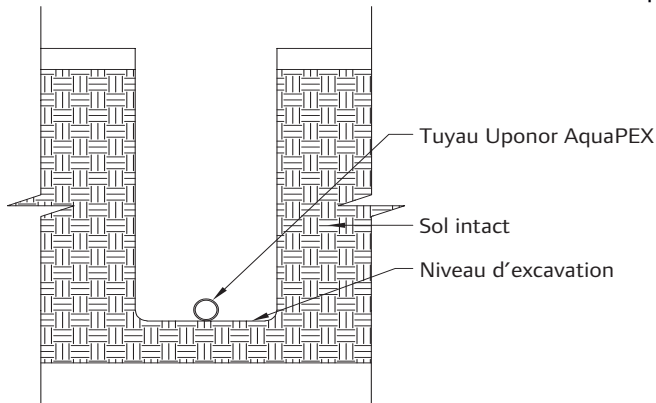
Condition du sol favorable — Si l'excavation de la tranchée se fait sans problème, installer la tuyauterie directement sur le fond préparé. Le fond doit être plat, sans trous, bosses ou cailloux.
